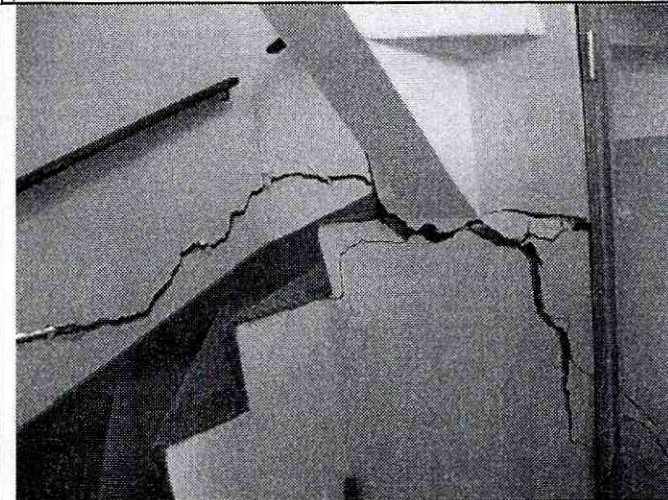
Predio CI 63 A Bis 14-46, detalle de la afectación en la escalera
